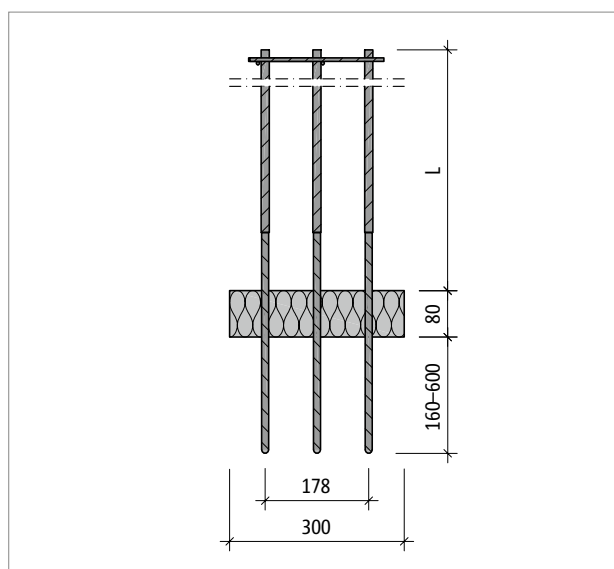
Schöck Sconnex® type W-T2-BW : coupe B-B du produit
